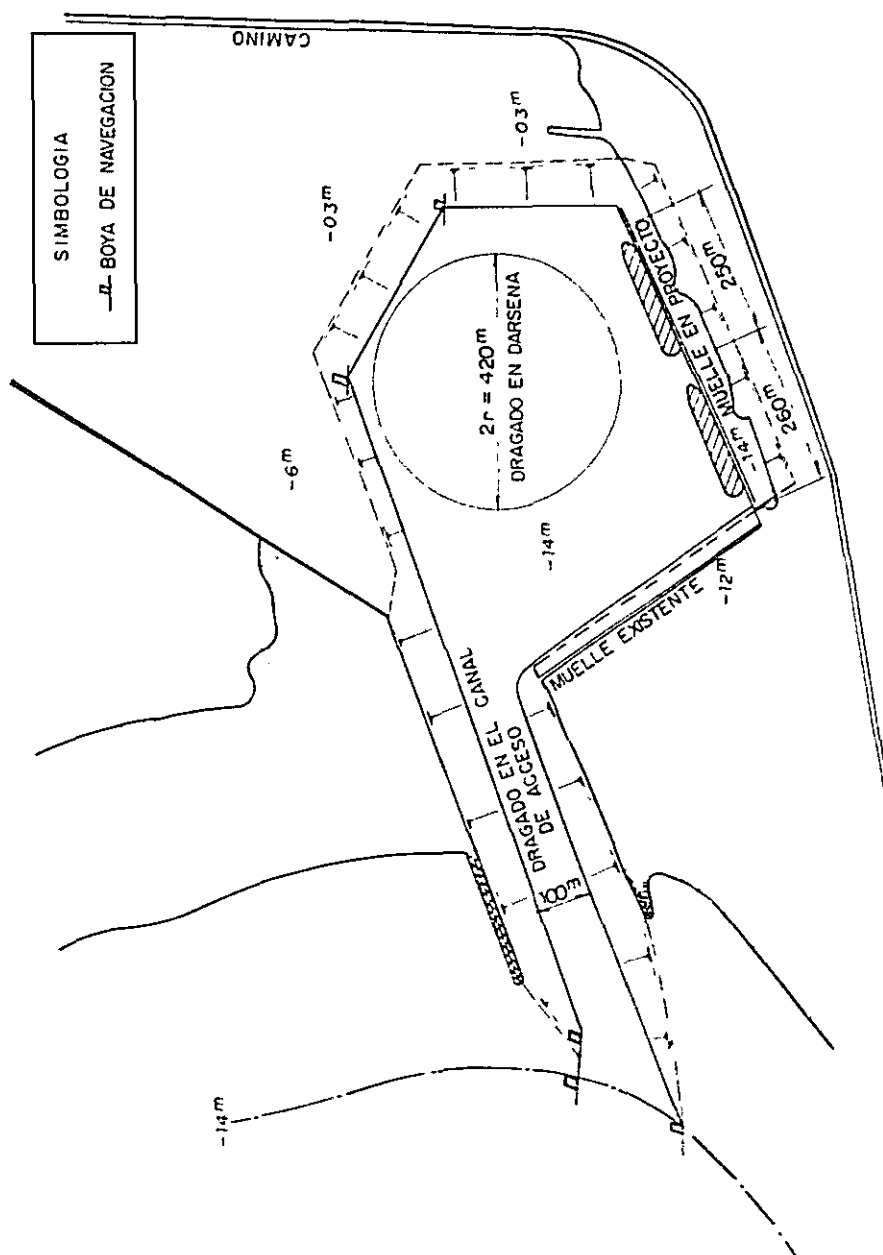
PROYECTO DE CANAL DE ACCESO Y DARSENA (MANZANILLO)
